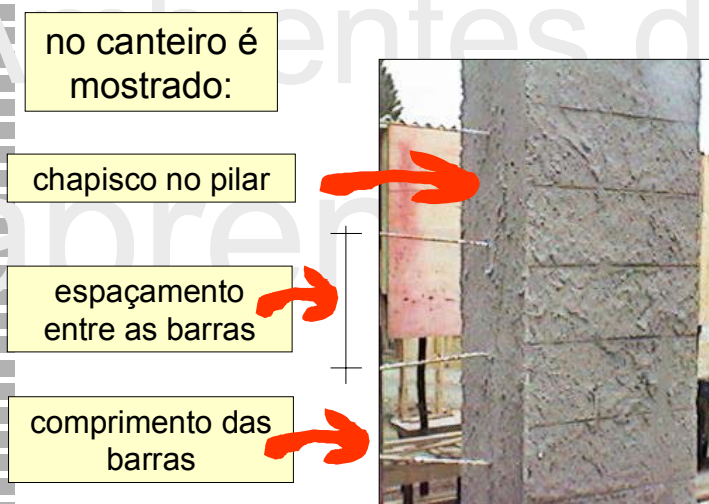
Detalhe da preparação da ligação pilar -alvenaria
